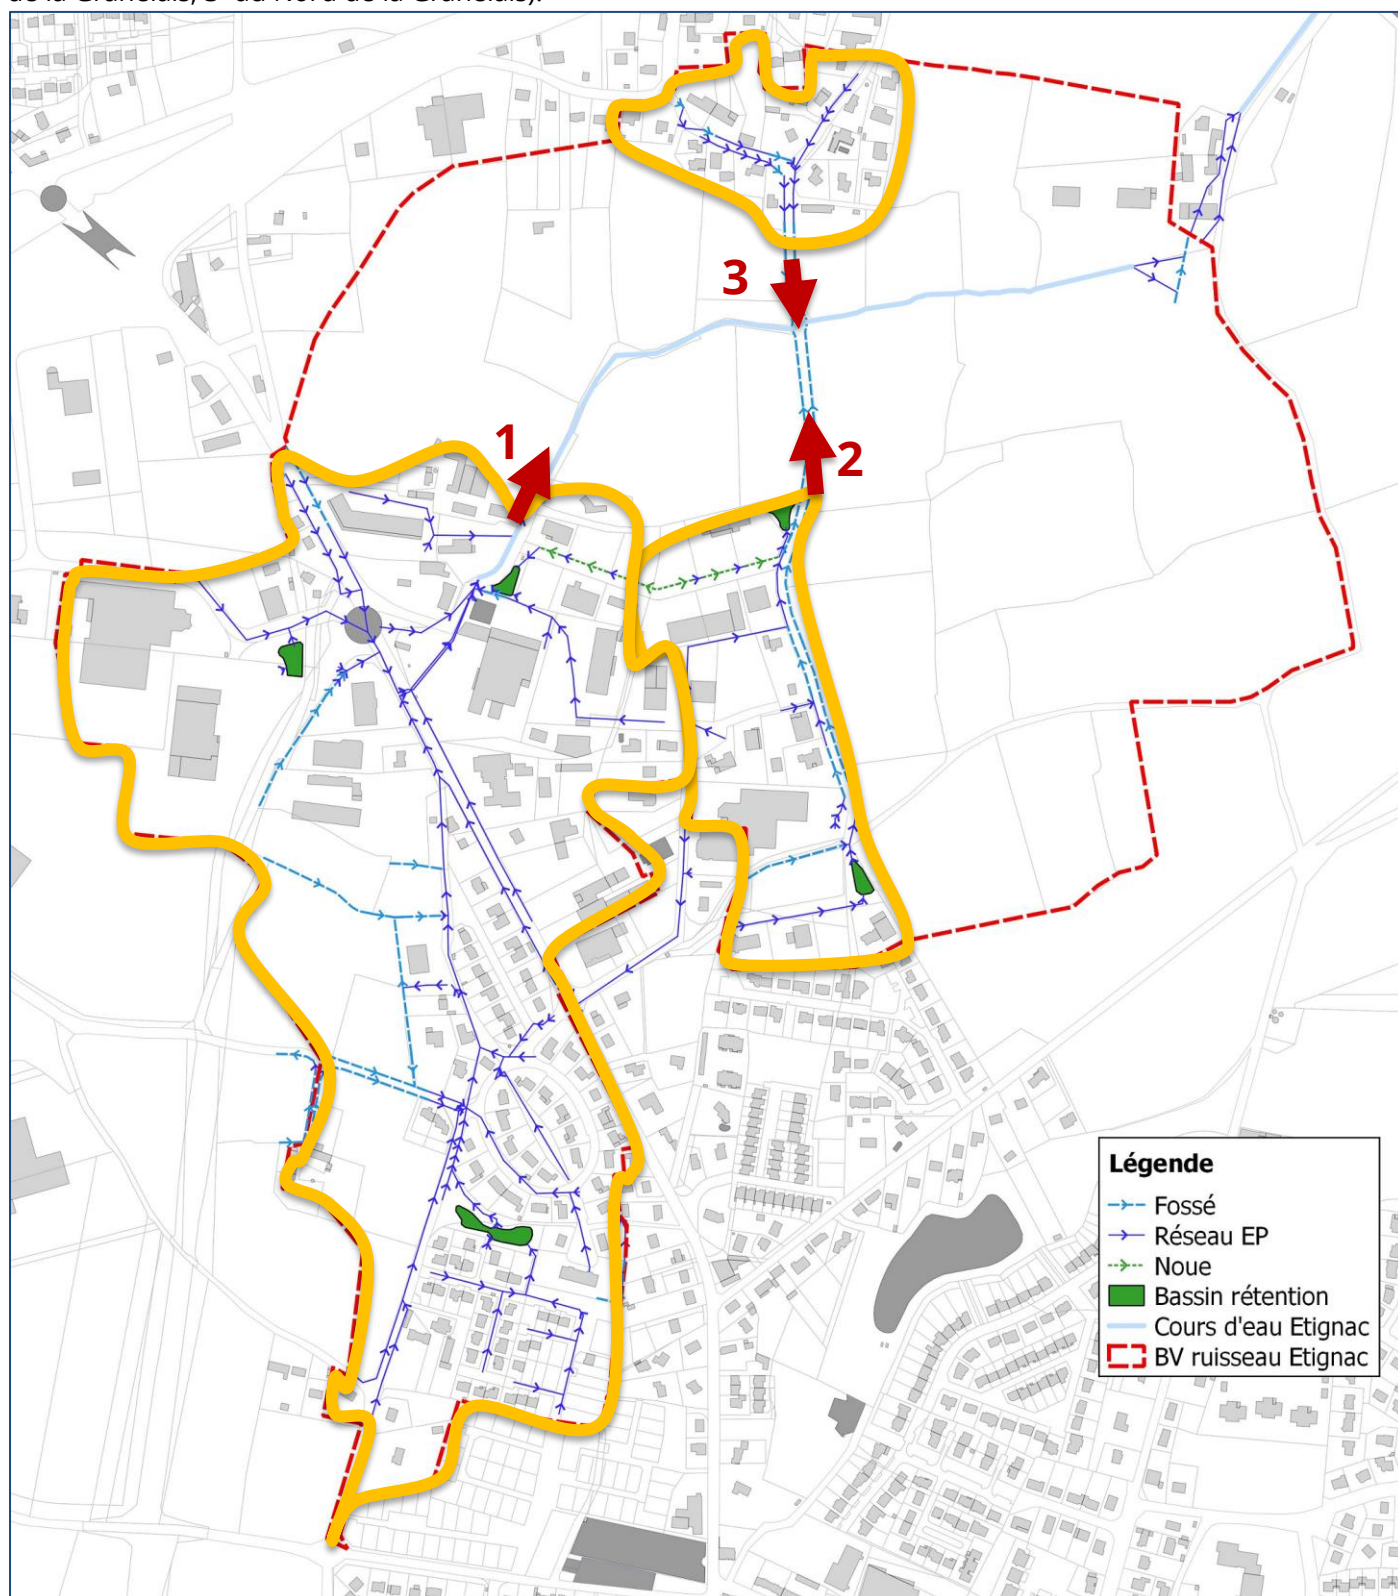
Plan du réseau pluvial du secteur (plan zoomé en annexe)
